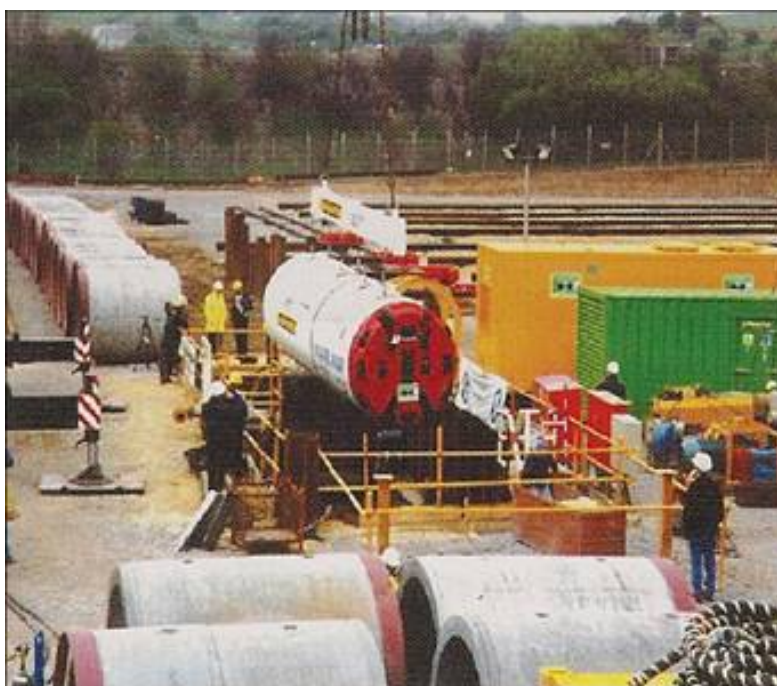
Outro exemplo de Shield para Pipe Jacking (em rocha), com os tubos de revestimento a serem cravados, pré fabricados, em 1º plano.
